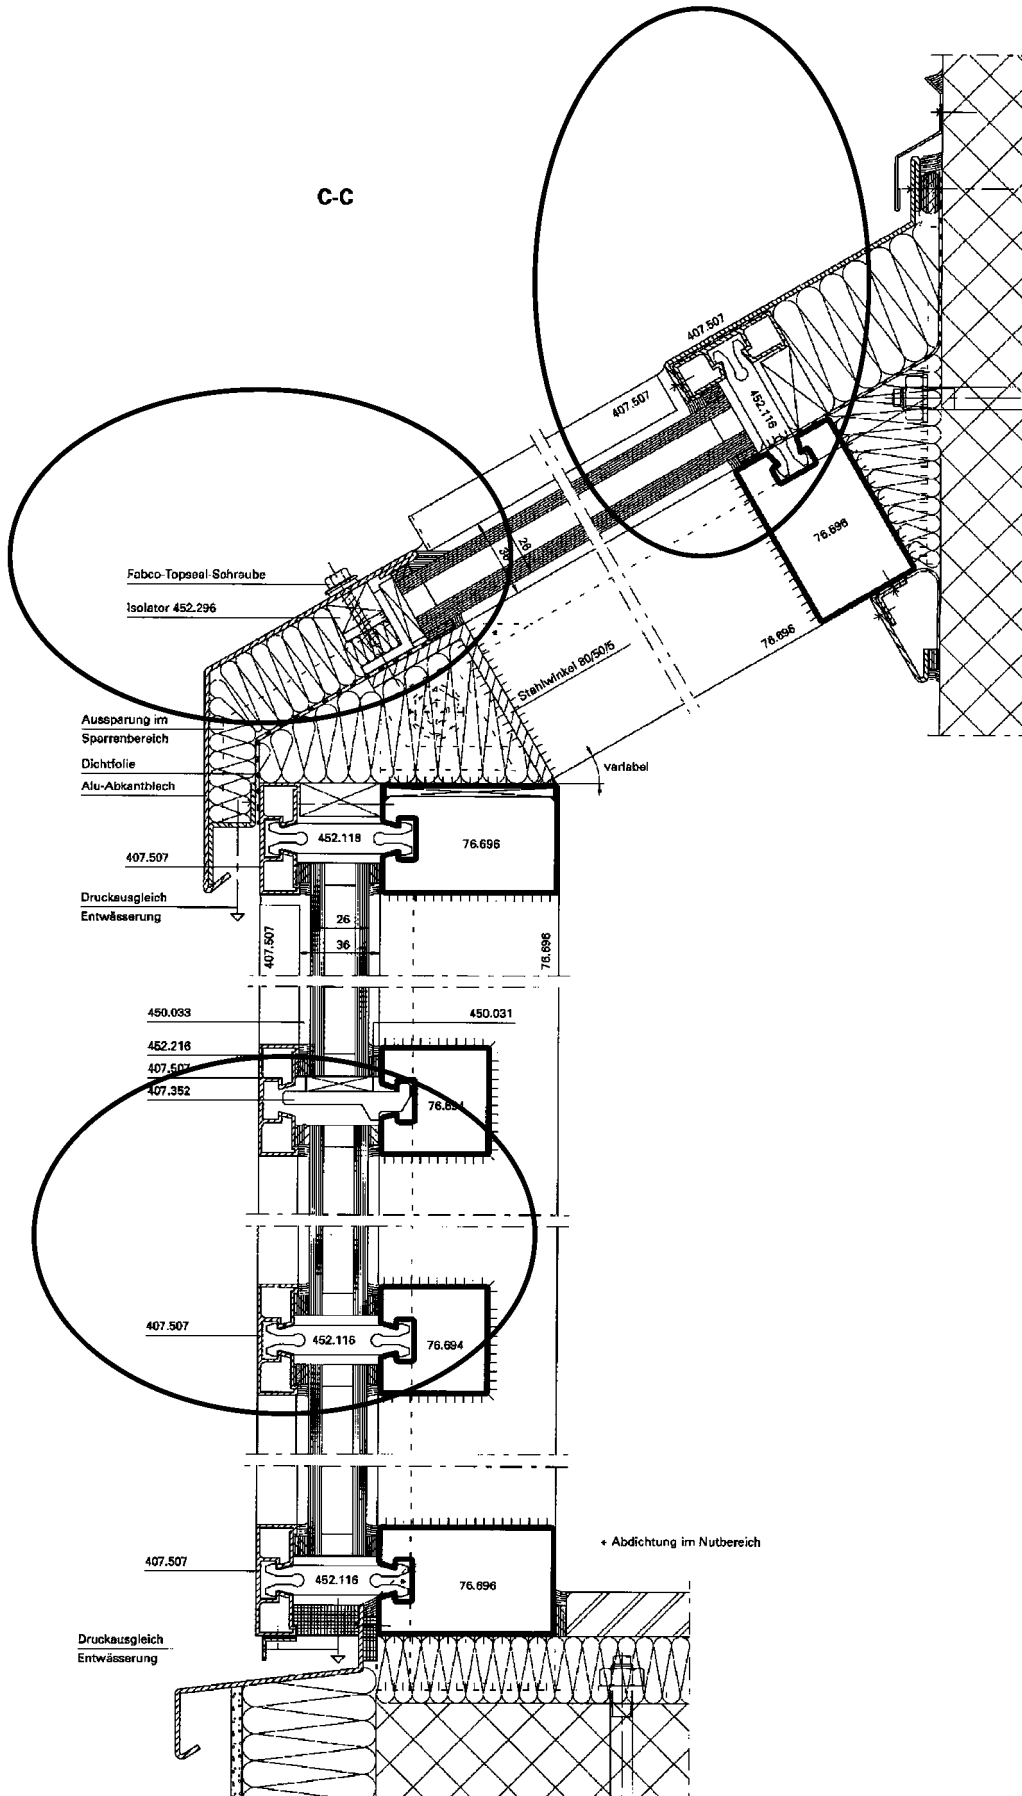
Detail ukončení u žlabu prosklené střešní konstrukce
